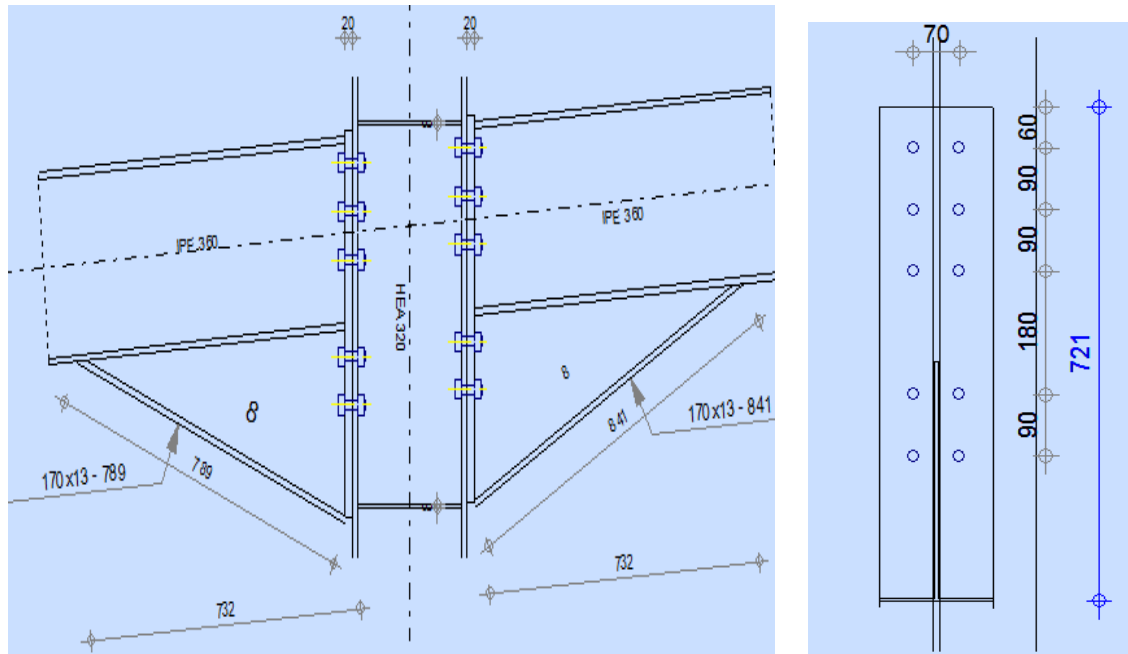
Assemblage du poteau central : dimensions et paramètres de calcul
